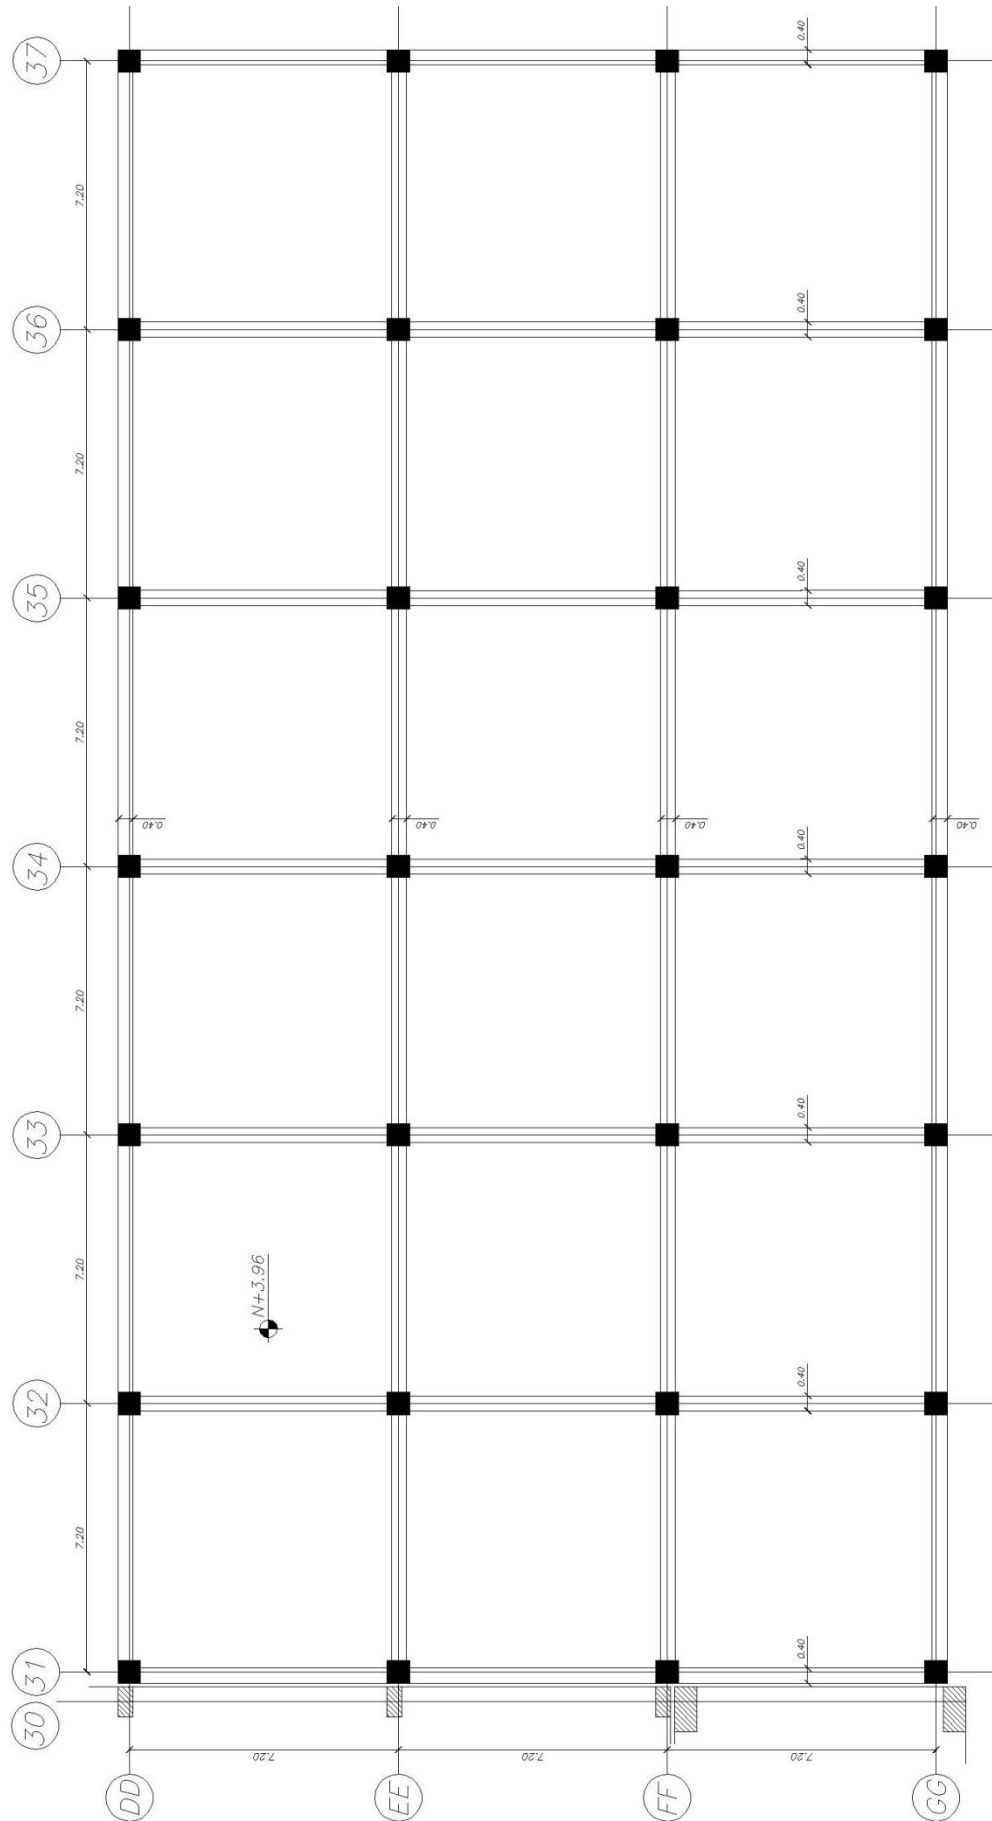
PLANTA ESTRUCTURAL NIVEL: +3,96 m OBSTETRICIA
